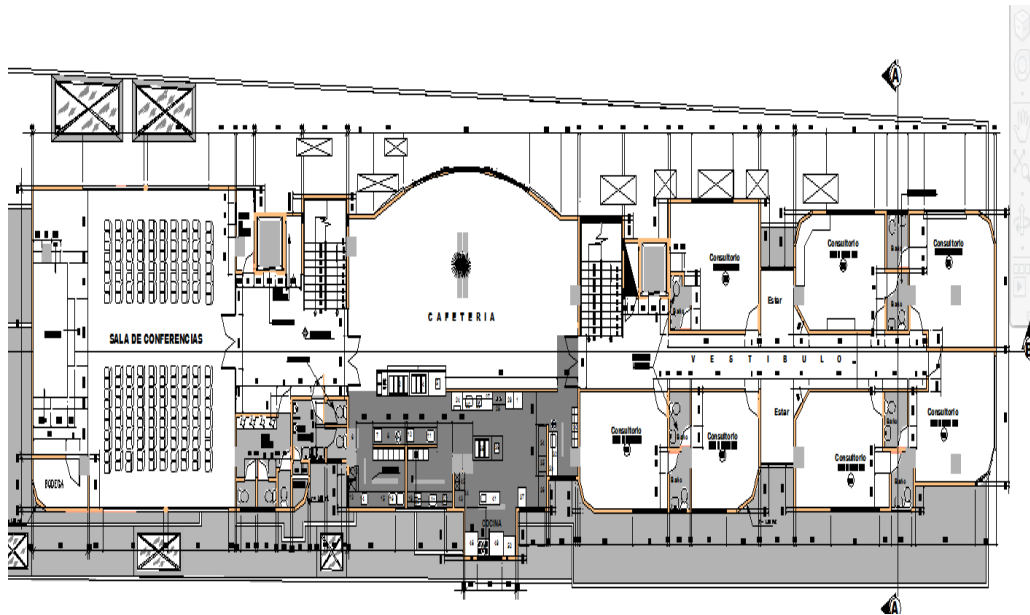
EJEMPLO DE LOS PLANOS FACILITADOS DEL HOSPITAL EN AUTOCAD (FUENTE: (ASOGALENICA S.A.))
